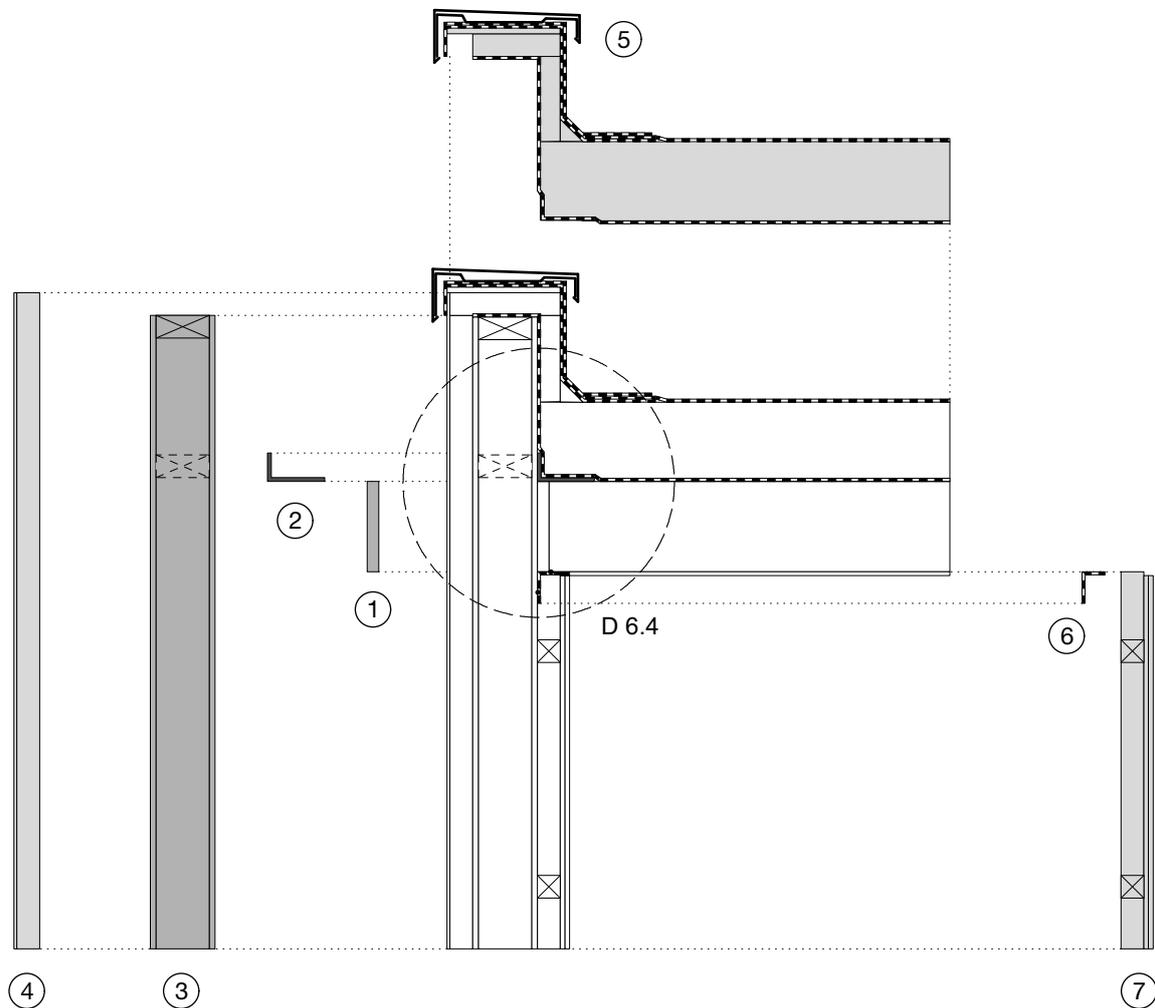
Montager Reihenfolge - Anschluss Flachdach mit Attika - Außenwand, vorgestellt
